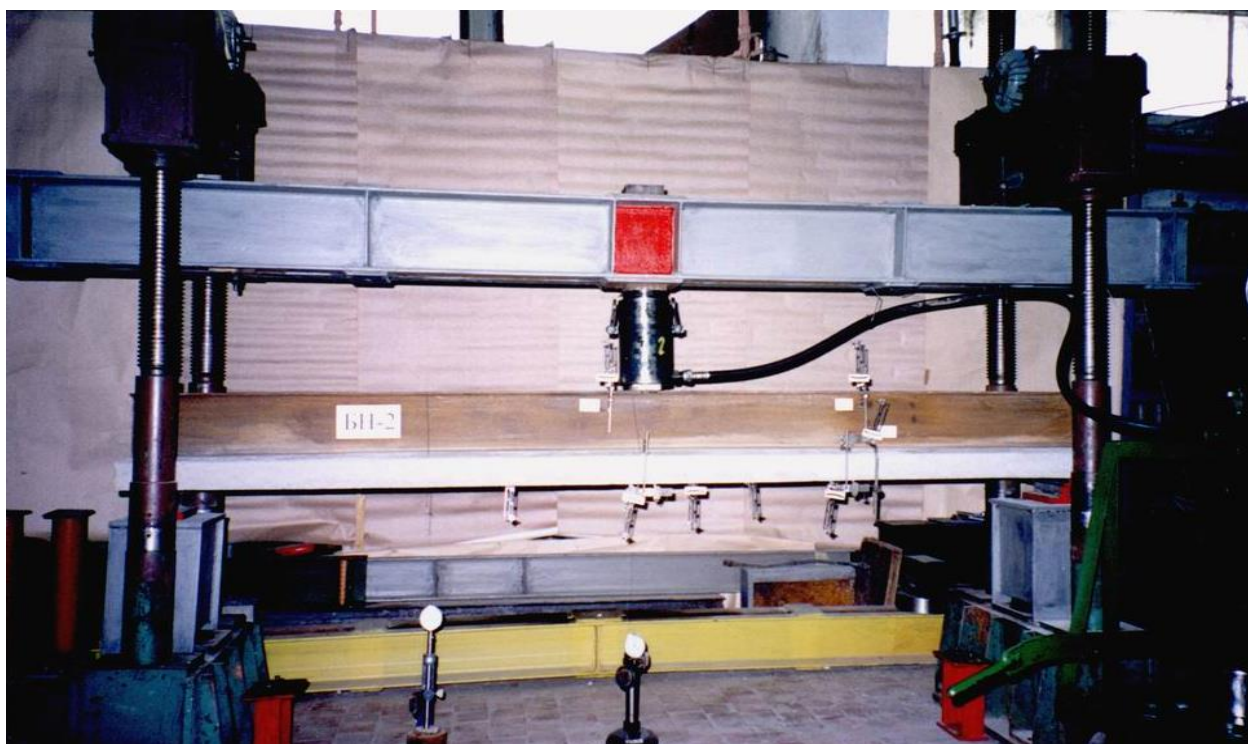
Общий вид испытания сталежелезобетонной балки с железобетонной полкой в растянутой зоне
